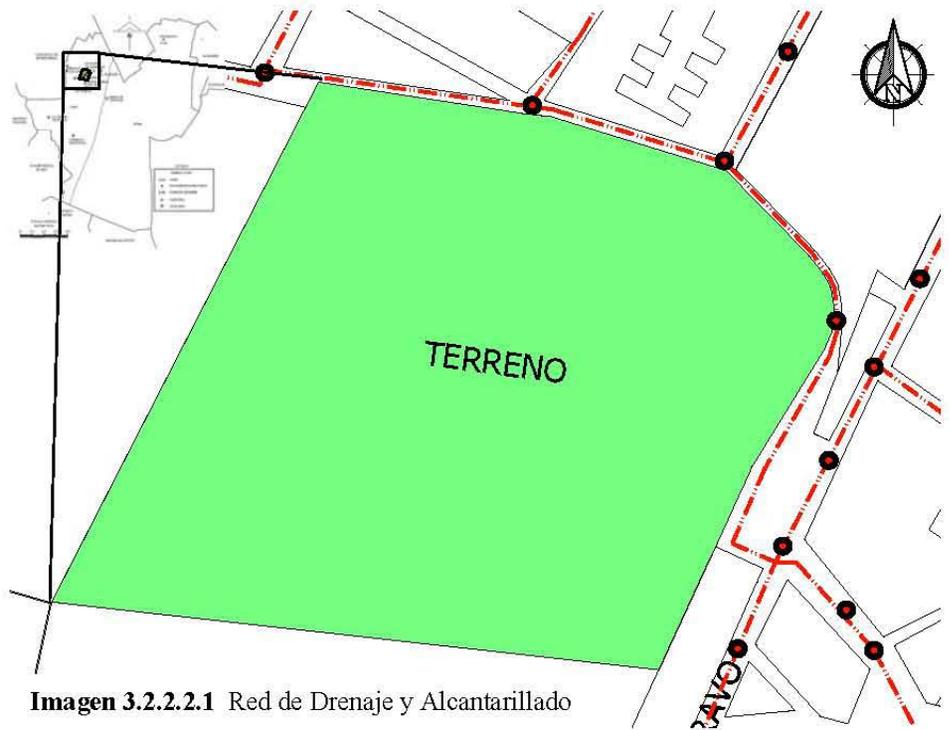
Red de Drenaje y Alcantarillado
